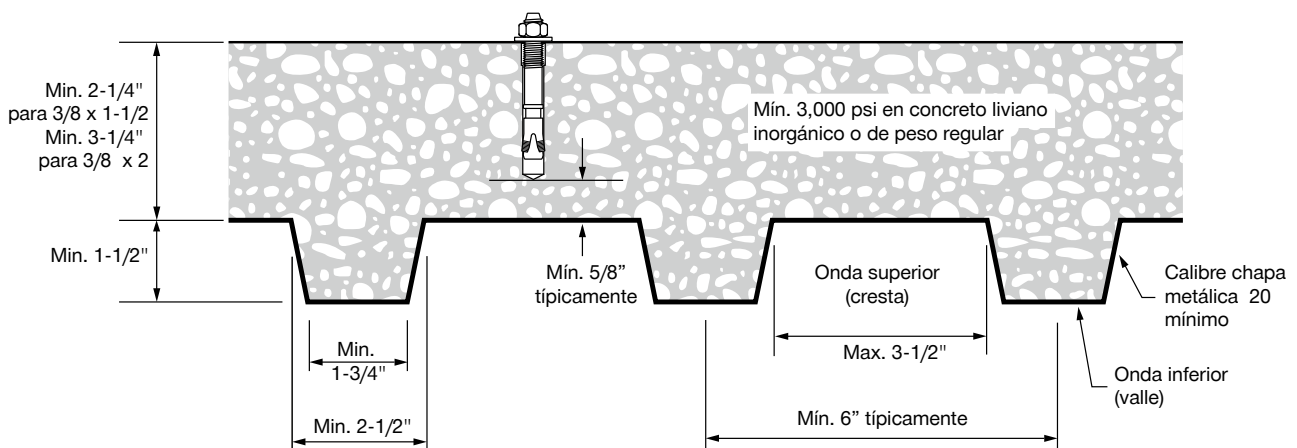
Instalación de Kwik Bolt VTZ sobre concreto liviano inorgánico en el piso de una chapa metálica en losa compuesta
